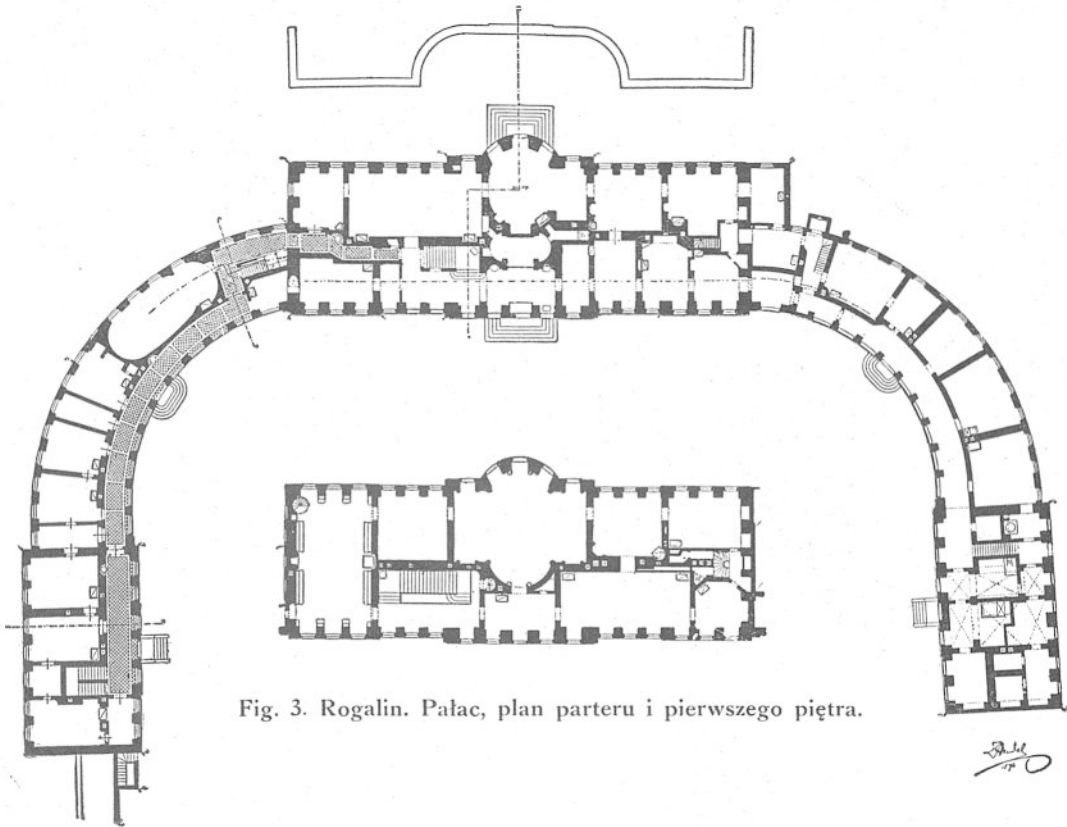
Rogalin. Pałac, plan parteru i pierwszego piętra.
